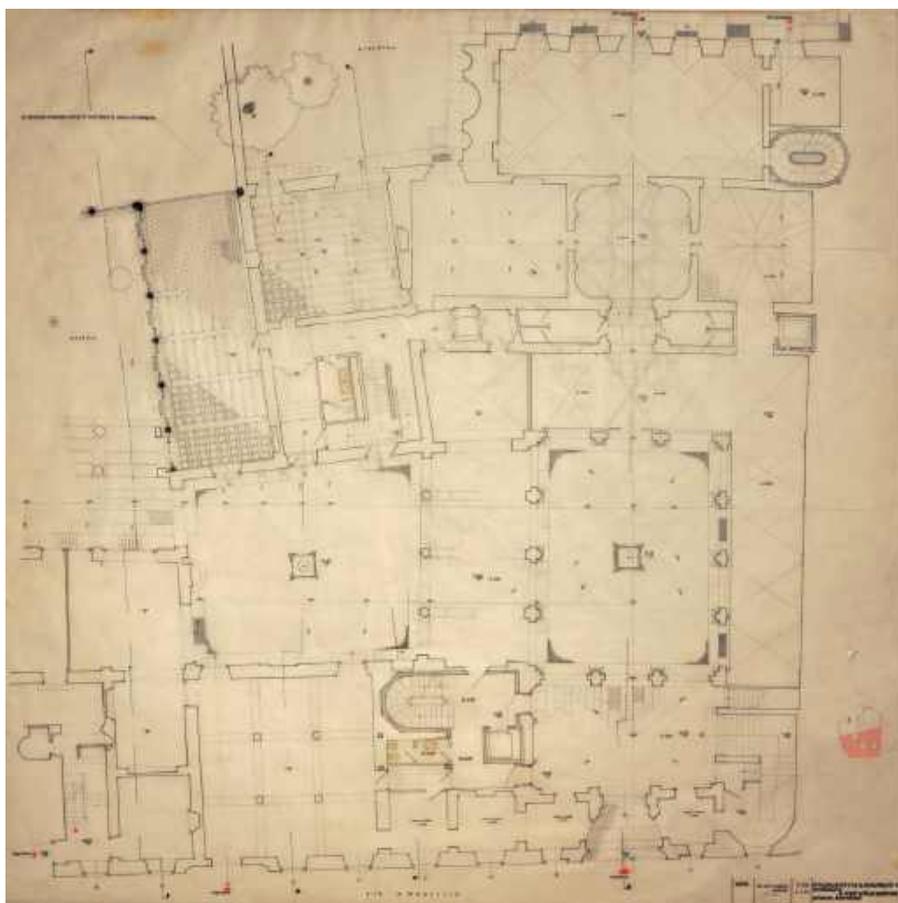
Stabile su via San Maurilio n. 19, corpo nord, pianta piano terreno, progetto di restauro e adattamento a banca; tavola su lucido
